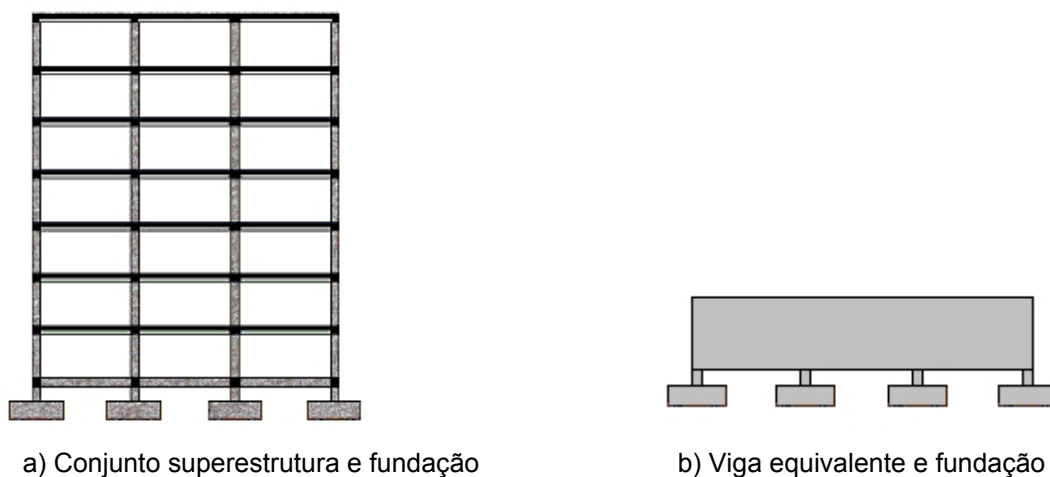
10 – Consideração da estrutura como uma viga de rigidez equivalente (Meyerhof, 1956).
